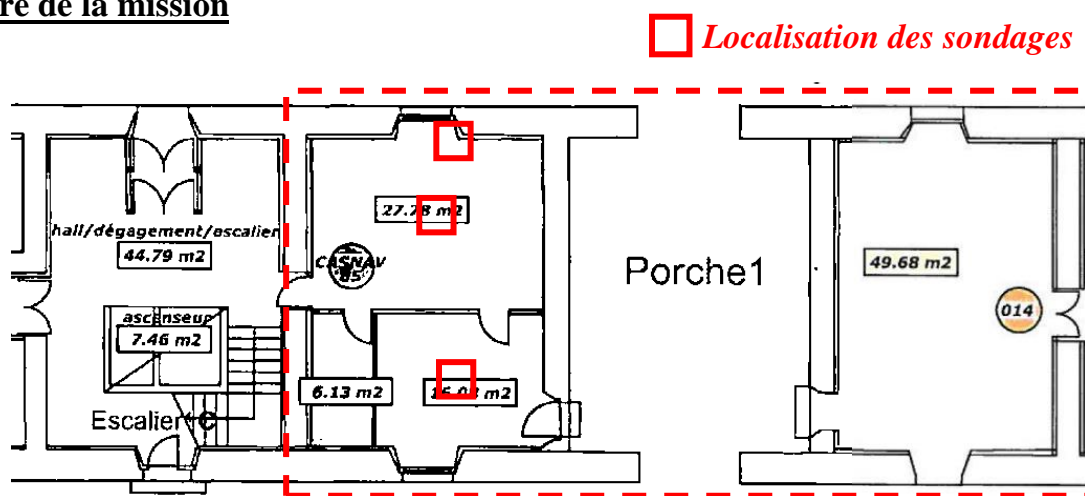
Vue en plan - Niveau Rez-de-chaussée
